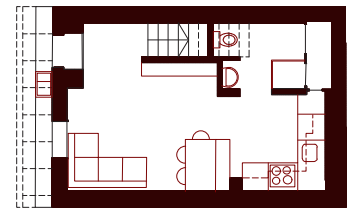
Planta baixa tipo B Ilha da Bela Vista - LAHBSocial
